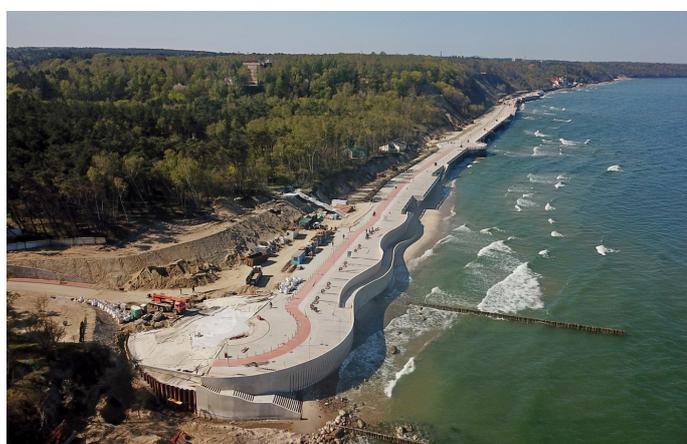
Общий вид строительной площадки променада в г. Светлогорск со стороны Балтийской улицы
